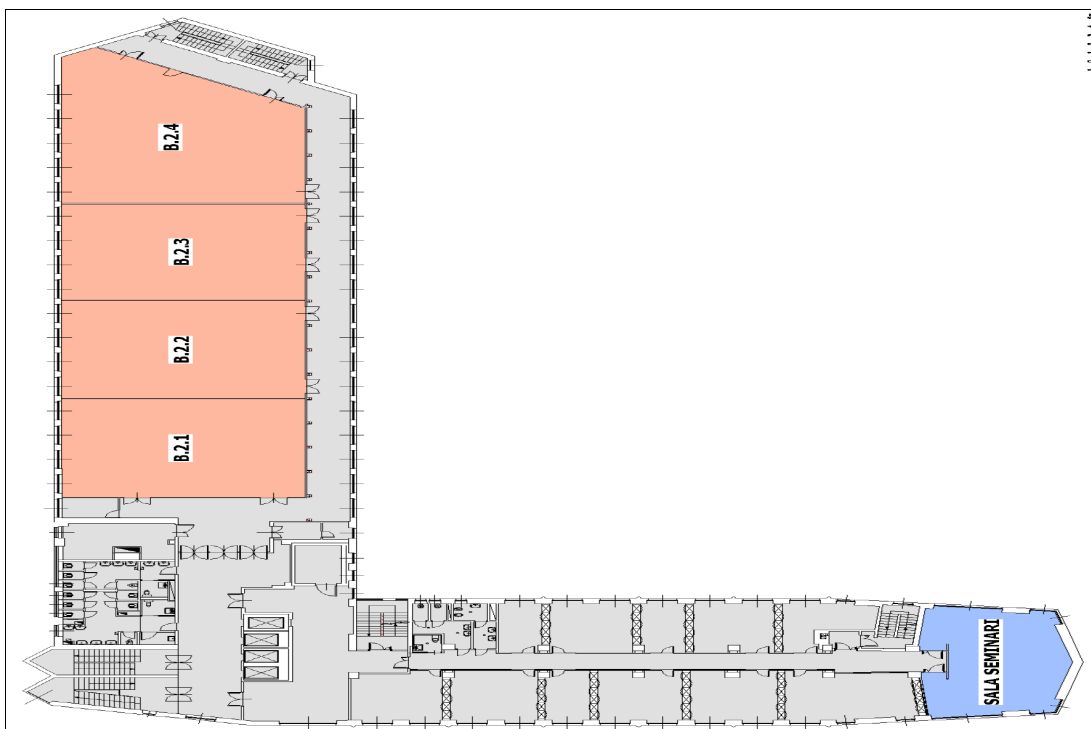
Planimetria del piano primo dell'Edificio 14 (Politecnico di Milano, 2012)
